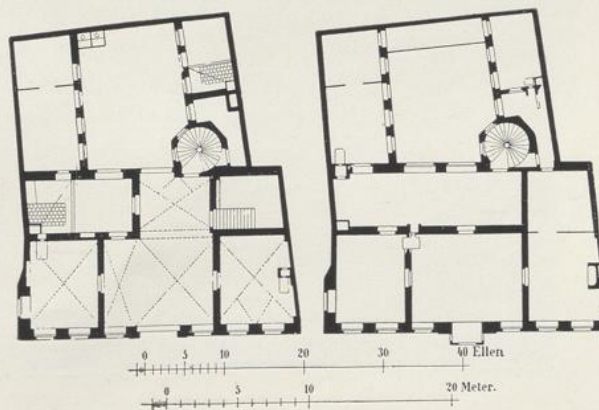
Löwenhaupt'sches Haus, Dresden. Grundrisse.
